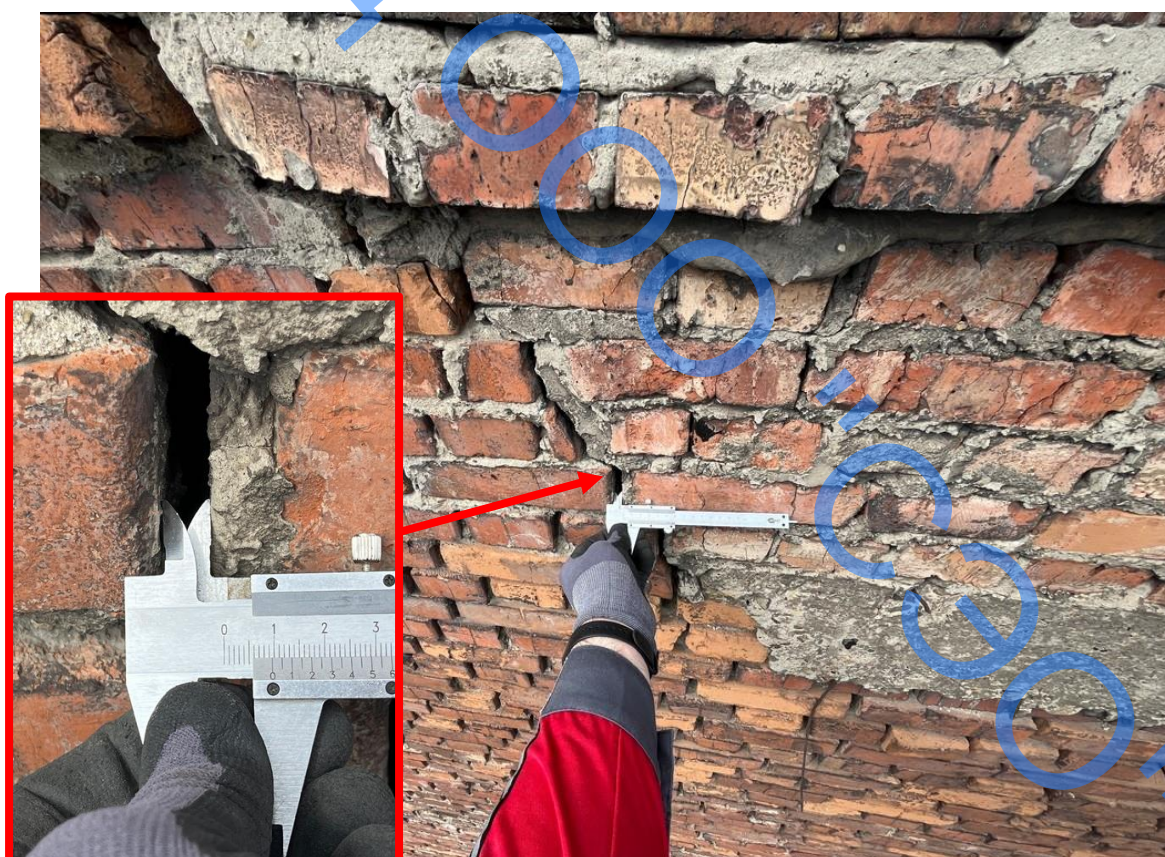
Сквозная трещина с шириной раскрытия до 9,6 мм
